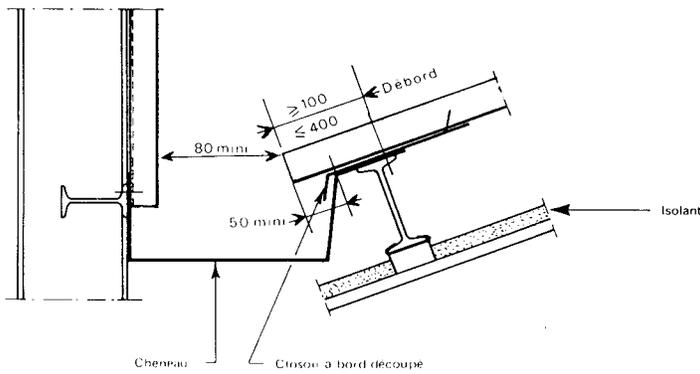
Egout - Chéneau - Raccordement d'une couverture et d'un bardage - Coupe verticale
